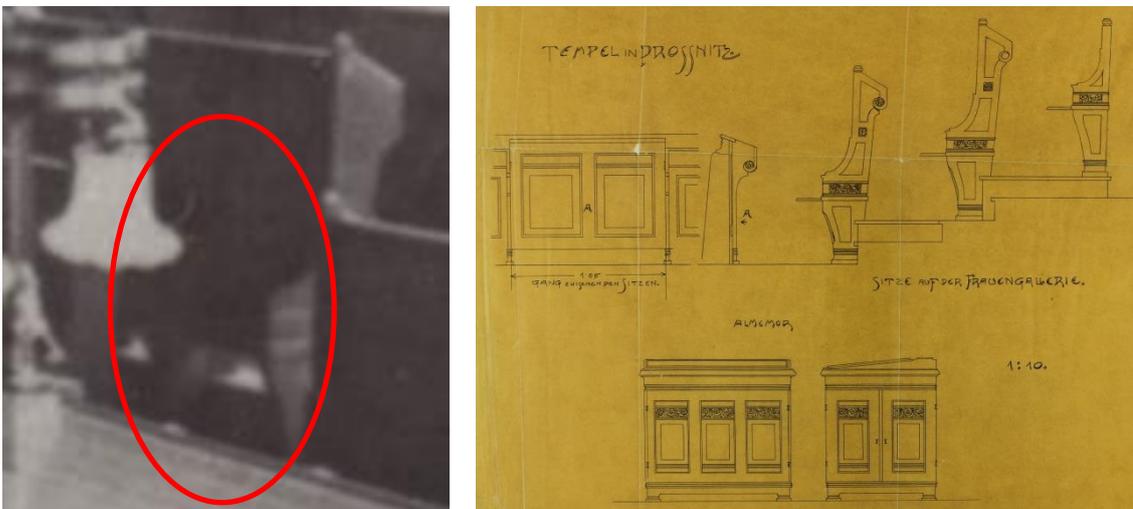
Holzboden Galerie (links), Mobiliar (rechts)
